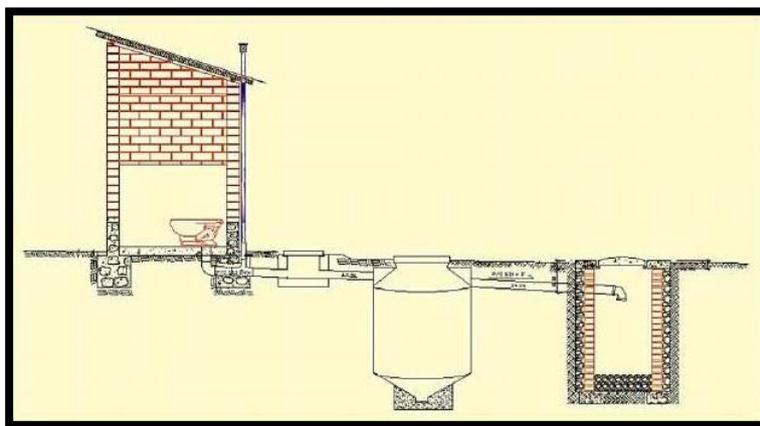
Vista en elevación de UBS con tanque séptico mejorado y zanja de infiltración
